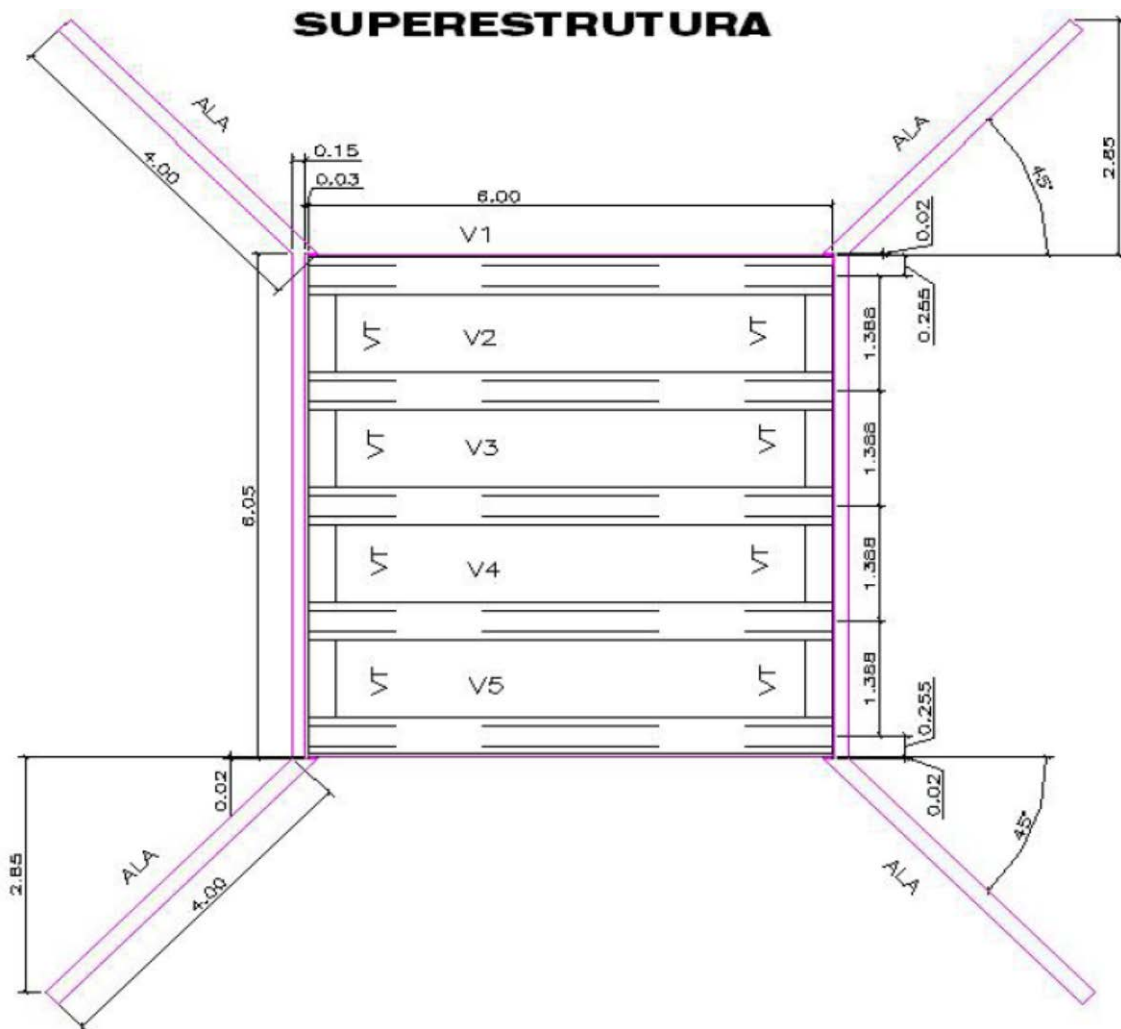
Croqui da Ponte a ser construída – Superestrututa
